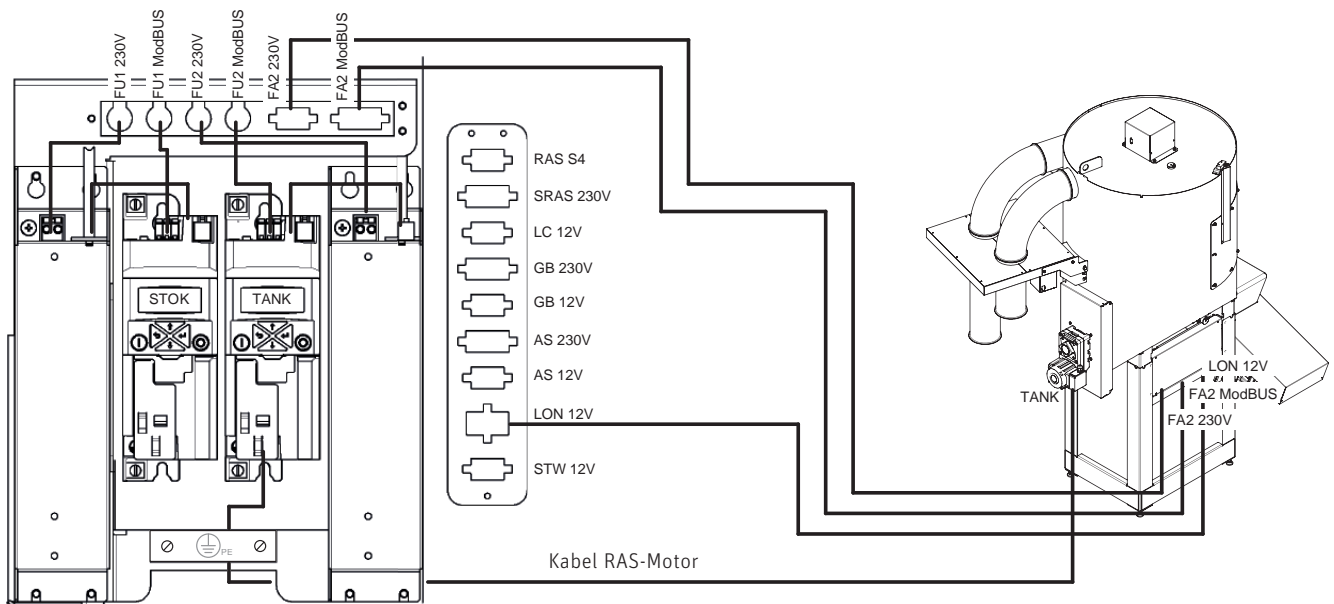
3 Stk. Kabel vom Schaltfeld 2 des Behälters anstecken
